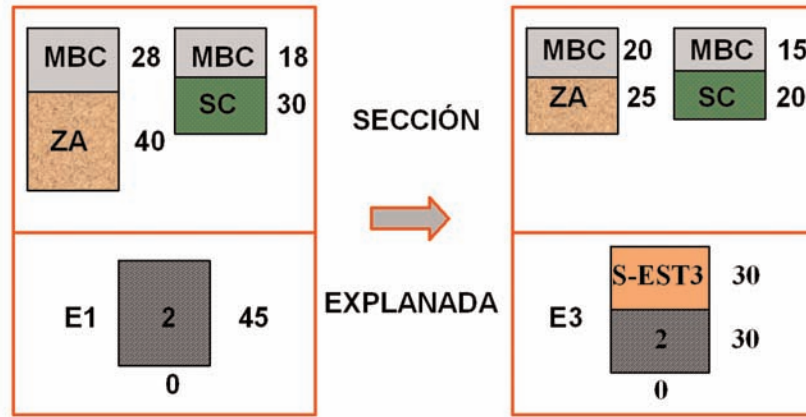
Ejemplo de diseño conjunto firme-explanada
